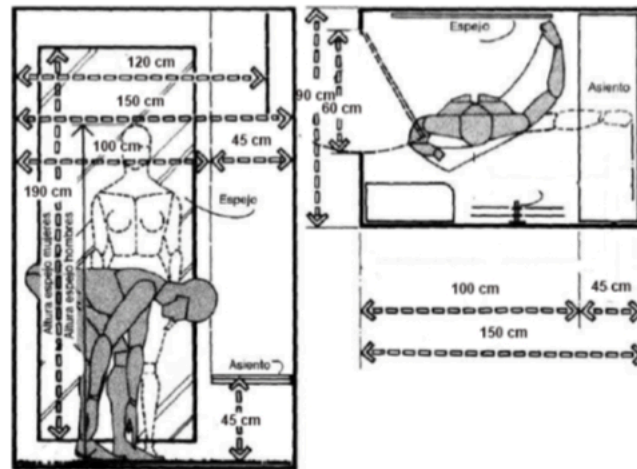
Cambiador individual, planta y elevación. Panero, 1983.
